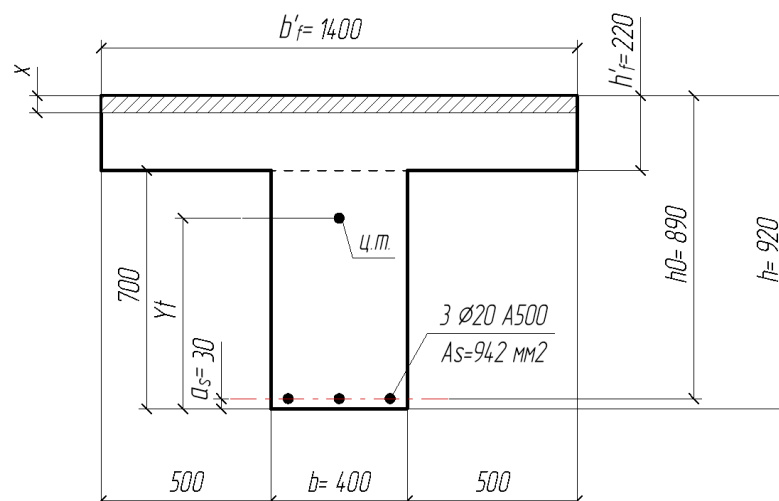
Расчетное поперечное сечение балки после усиления
